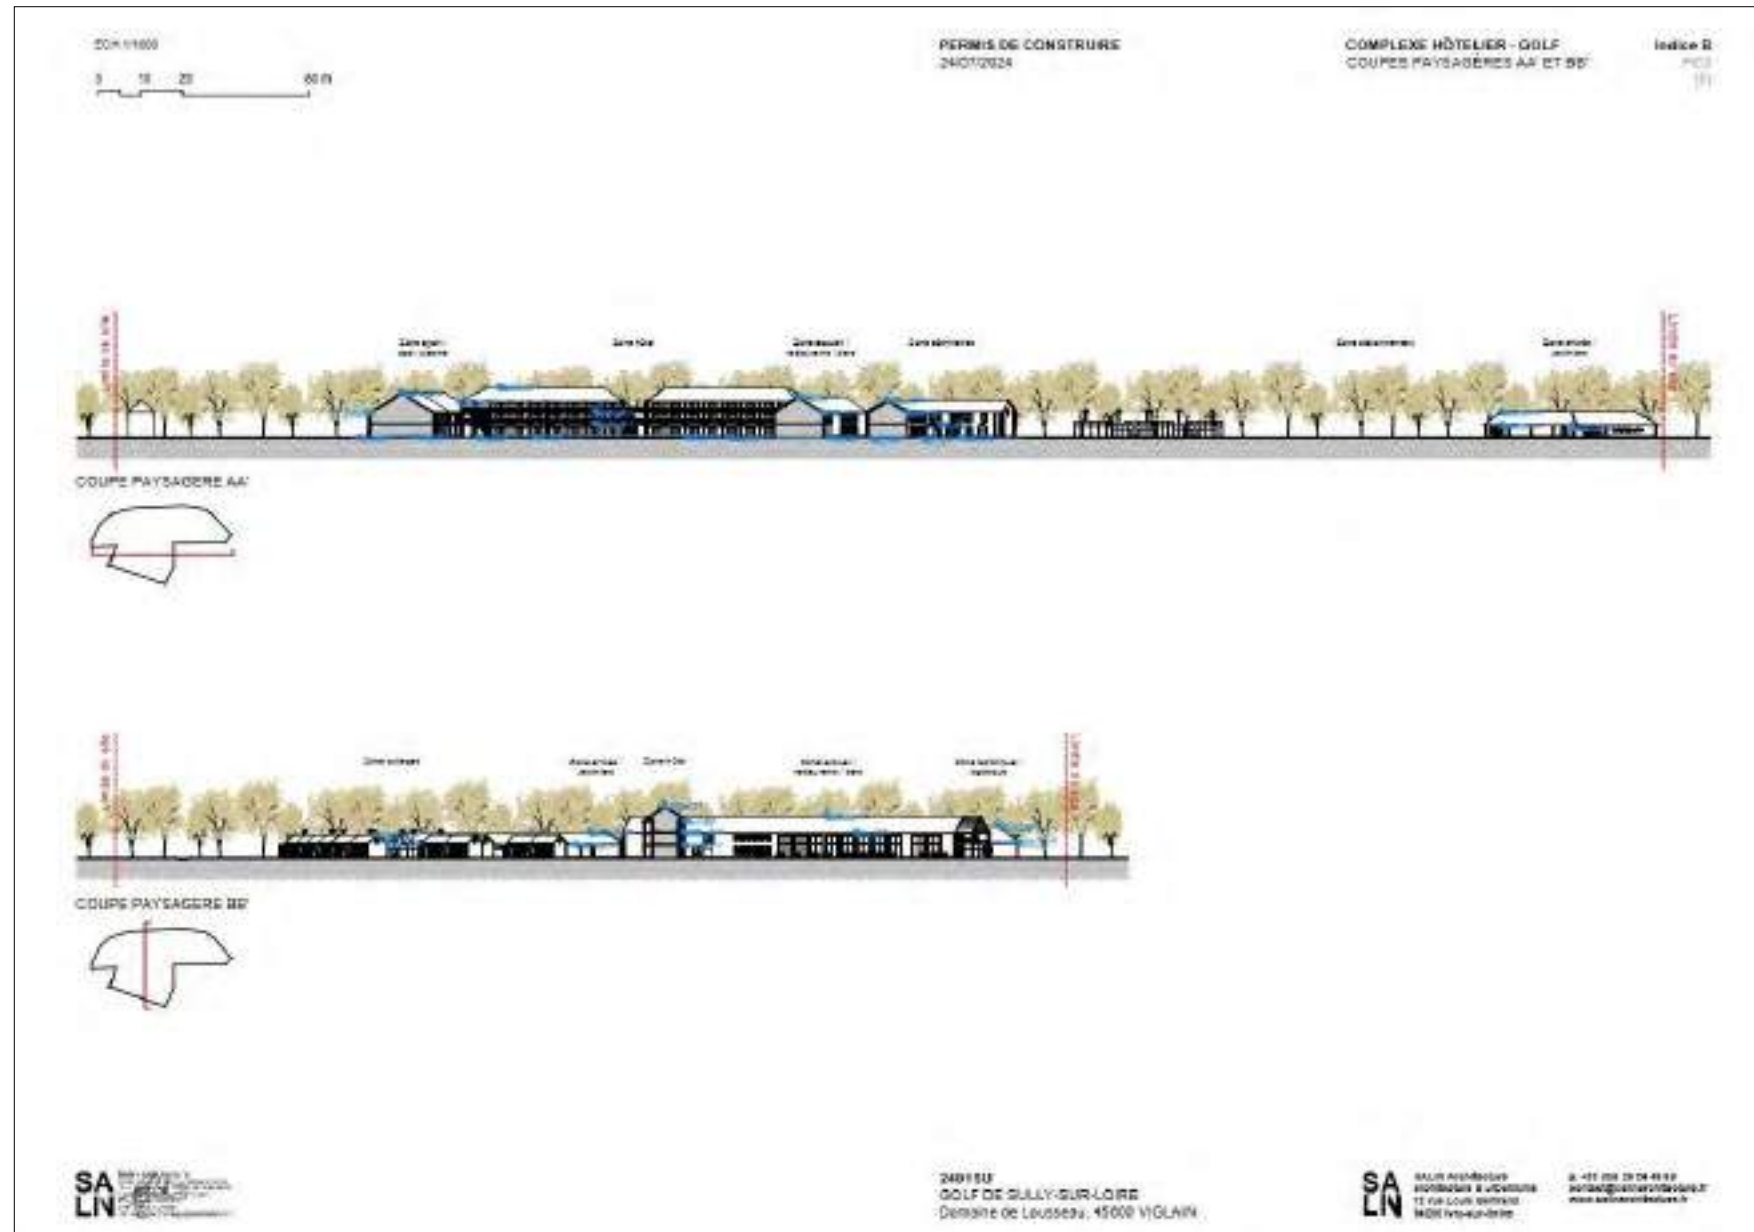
Coupes paysagères du projet (Source : SALIN architecte 24/07/2024)
